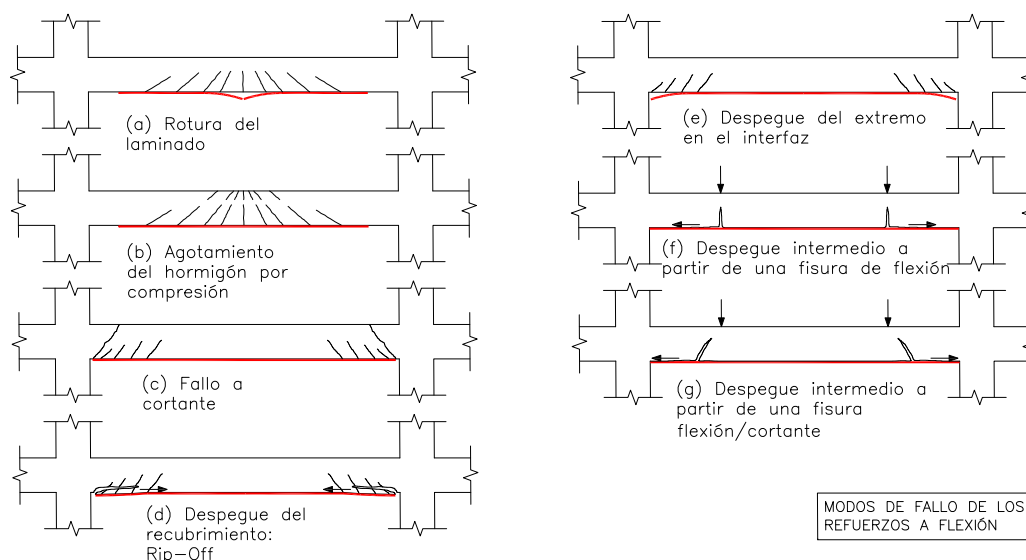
Font: *La fibra de carbono en refuerzo de estructuras de hormigón*. Institut d'Estudis Estructurals (ACE)
